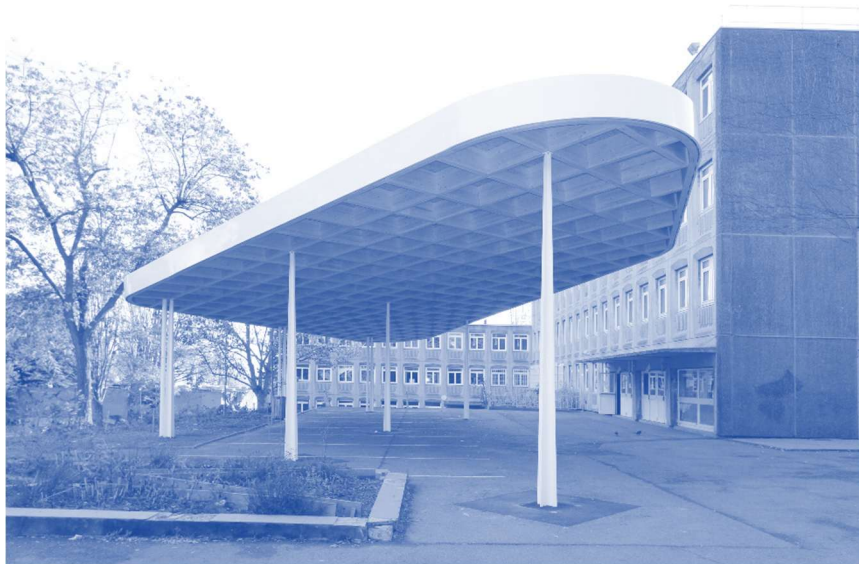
PHOTO DU BATIMENT LIVRE — (SOURCE : I+A LABORATOIRE DES STRUCTURES)
